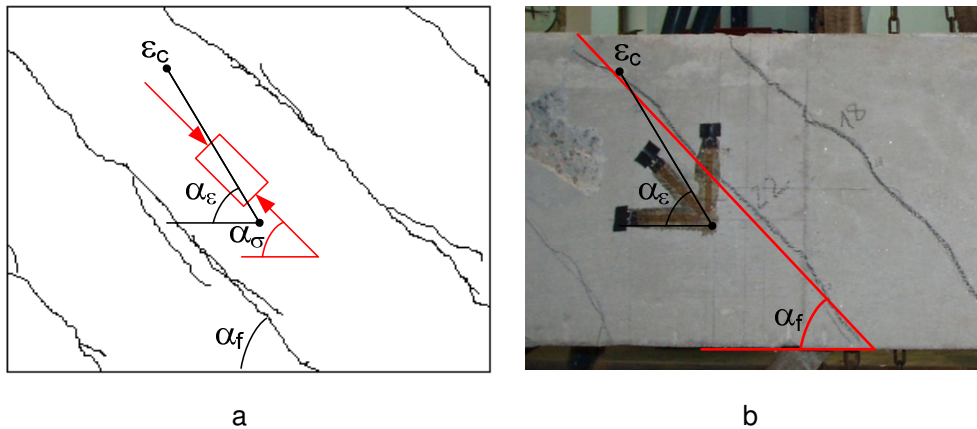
Deformações específicas: a) painel fissurado; b) viga VRef.
